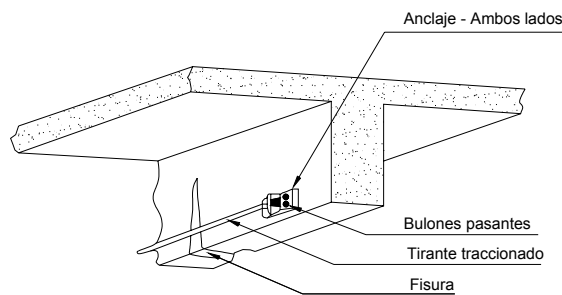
Orientación de las barras de armadura utilizadas para reparar fisuras (Stratton et al., 1978)
